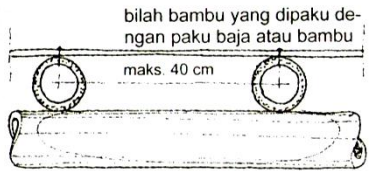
Penutup lantai bilah bambu pada lantai batang bambu
